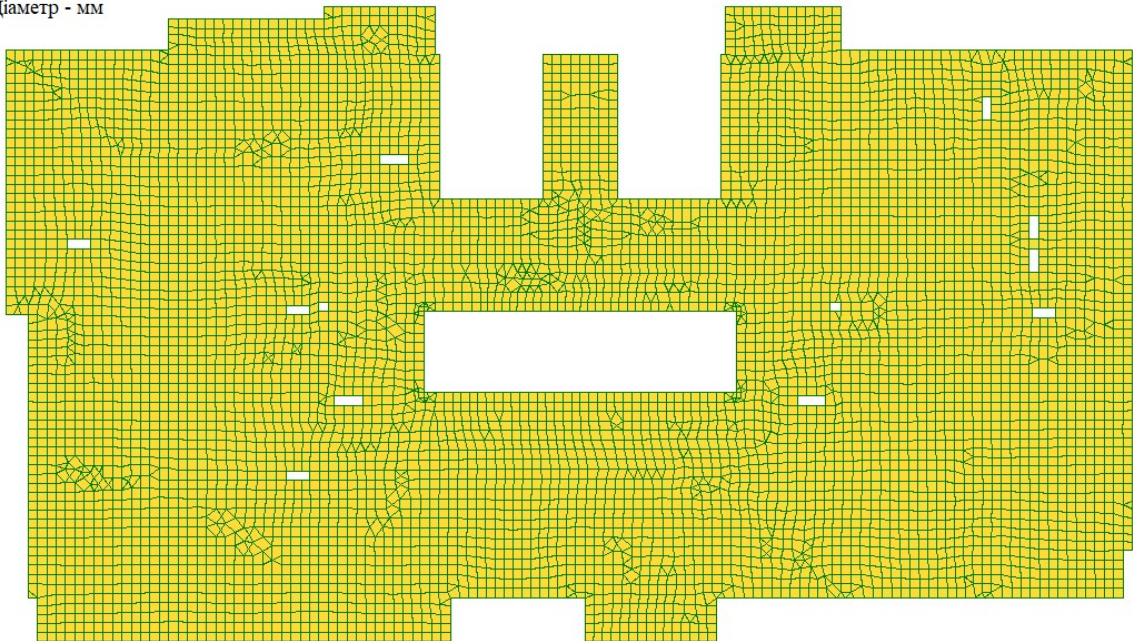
Площа повної арматури на 1м вздовж буквених осей у нижньої грані бетону (мм²)
